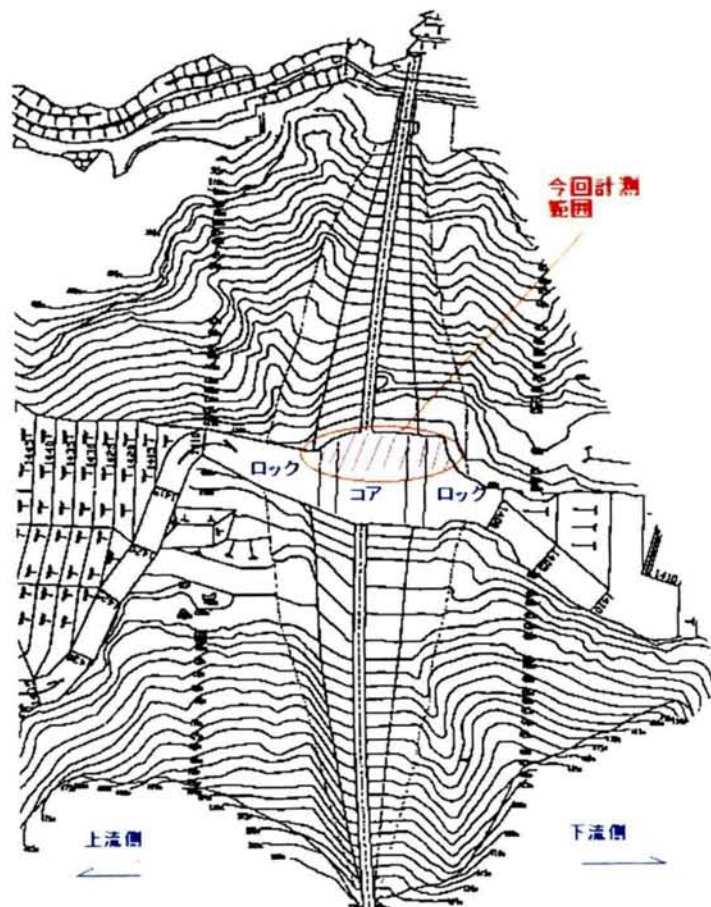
締固め管理システムを試用したある中央遮水壁型フィルダムの平面図
